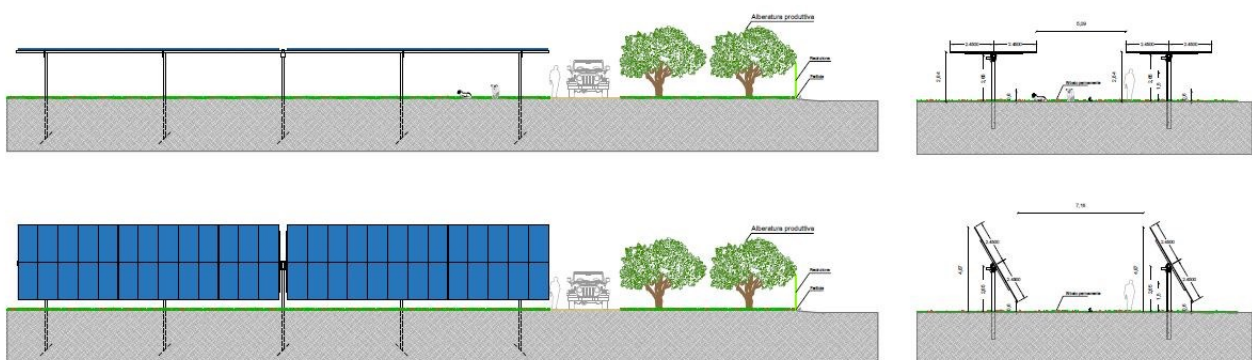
Sezione significativa del sistema di mitigazione perimetrale
